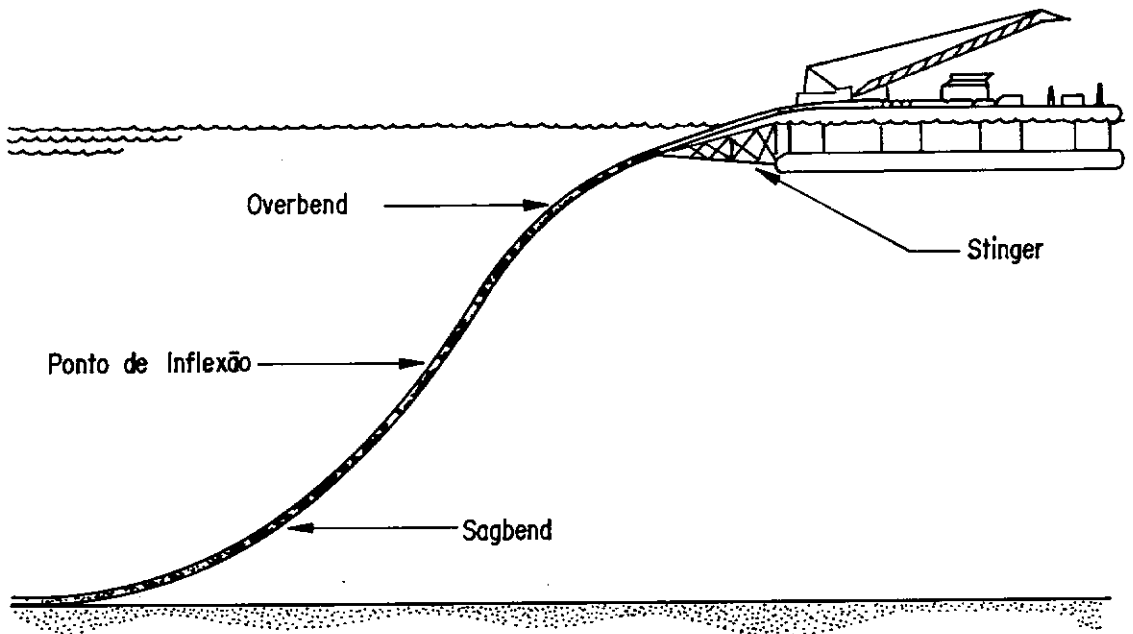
Lançamento com barcaça - configuração deformada típica do duto.
